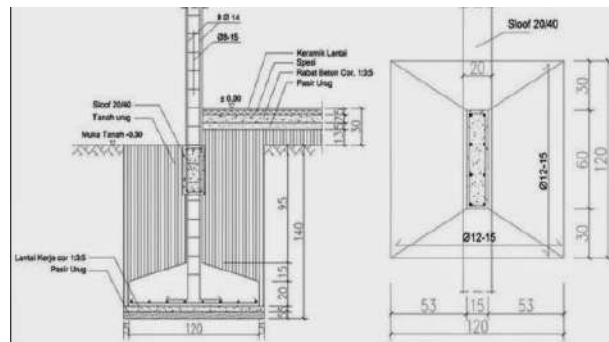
Konsep Struktur (Pondasi Jalur)
